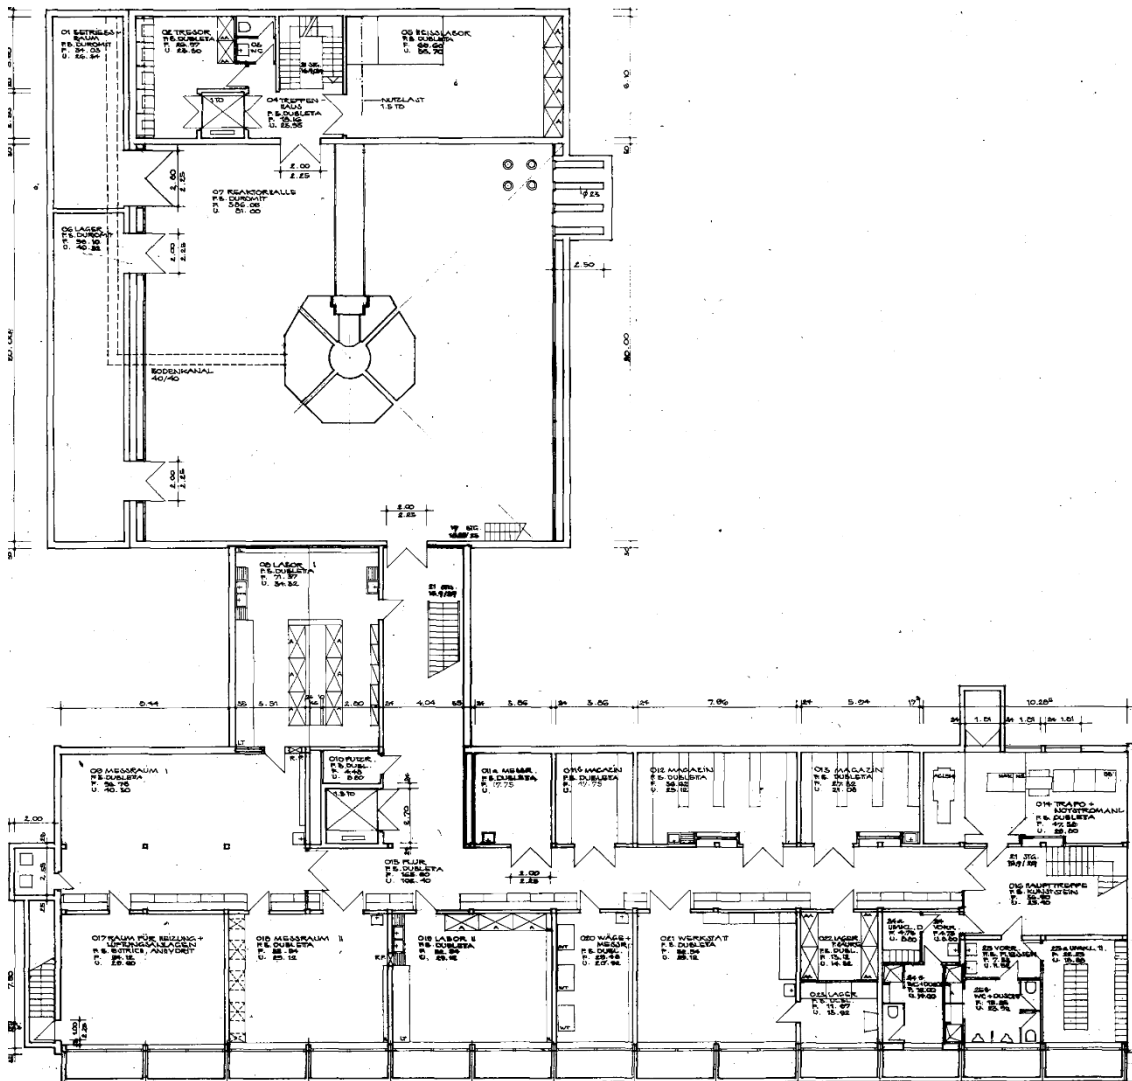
Grundriss Kellergeschoss des FRMZ /MEN 62/
